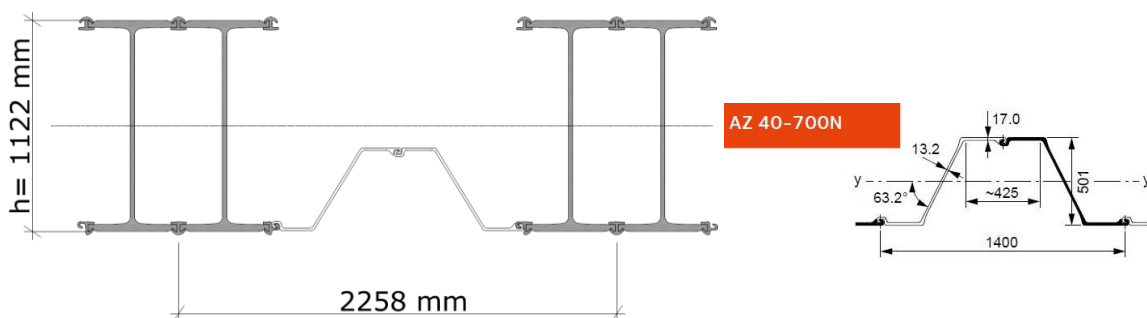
Detalle del perfil de la tablestaca principal de la sección 1 de la tablestaca trasera (derecha) de la Sección 1
